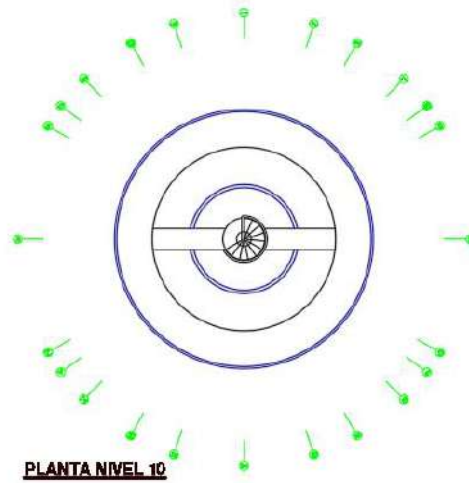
Planta del décimo nivel. (Fuente Autor)
